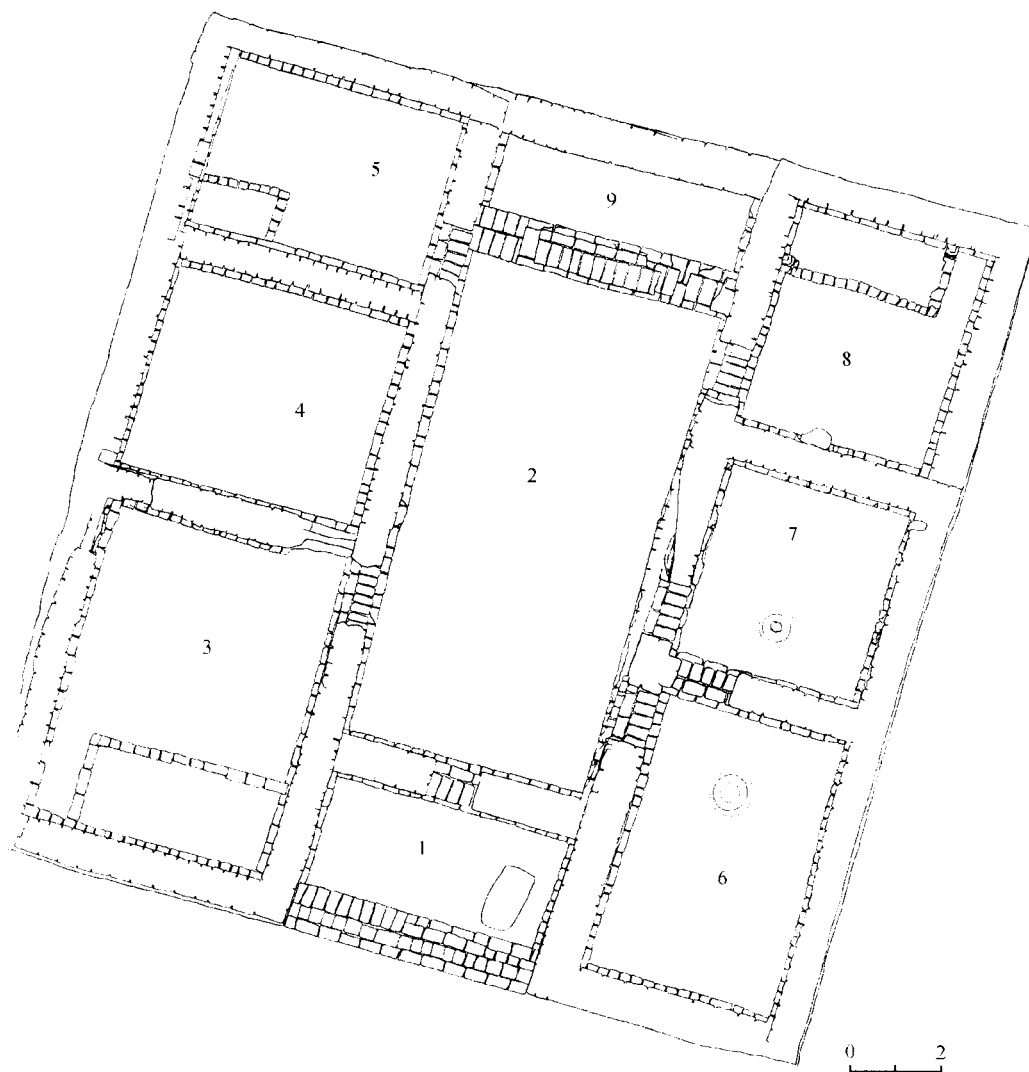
Здание на XV раскопе, общий план на уровне цокольной части.
